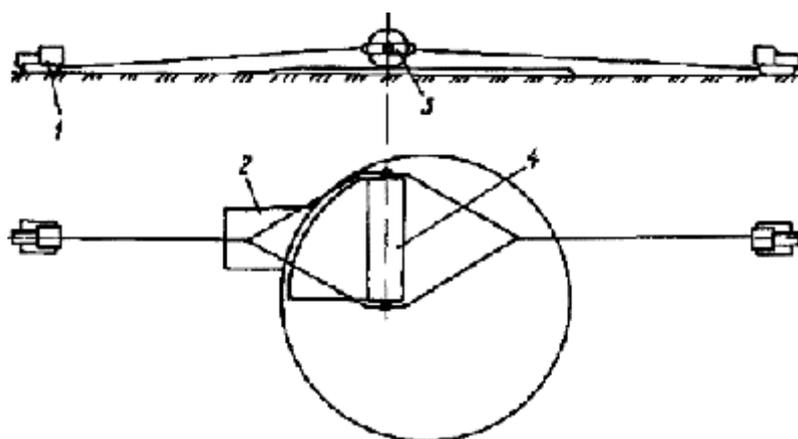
Развертывание рулонов днища резервуара специальным приспособлением
